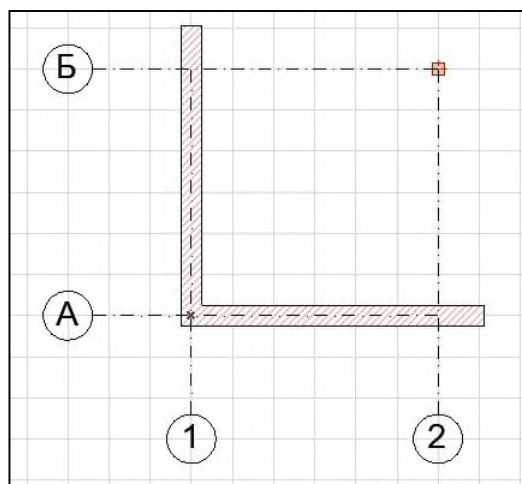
Фрагмент плану будівлі напівкаркасного типу
